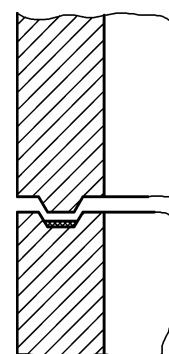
c) — Garniture d'étanchéité élastomère ou plastomère ou autre matériaux d'étanchéité
